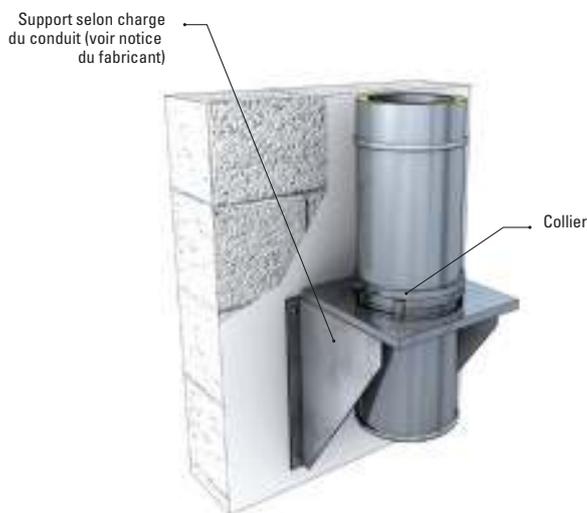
Support mural d'un conduit de fumée. Le conduit doit déboucher en intégralité dans le local où se situe l'appareil (et non dans un faux plafond).
